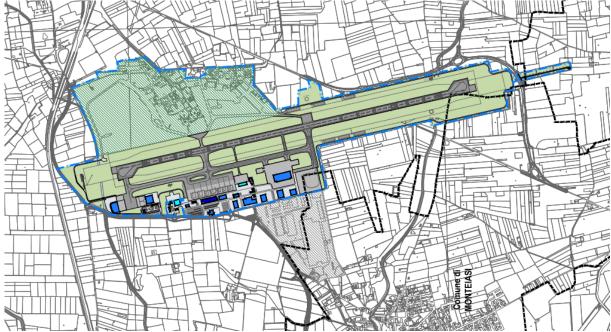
Configurazione finale dell'aeroporto secondo il layout infrastrutturale individuato dal PSA
